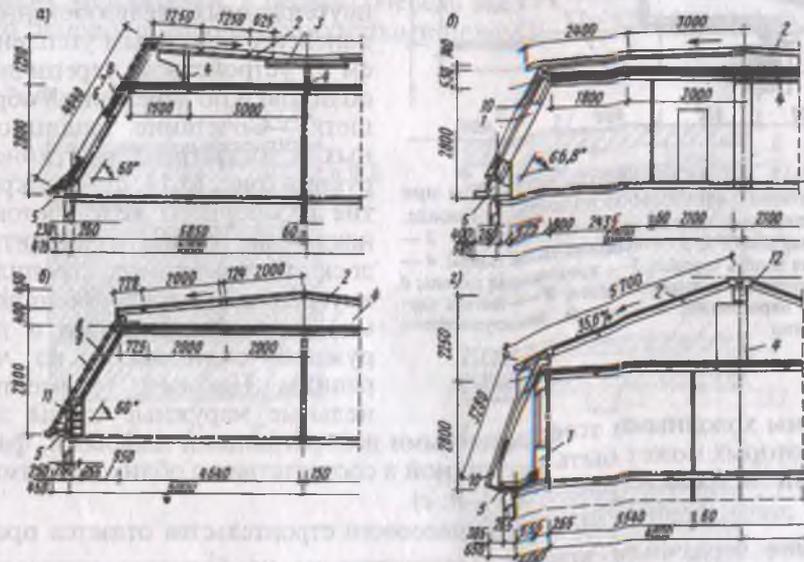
Примеры конструкций сборных железобетонных крыш мансардного типа (Германия):
